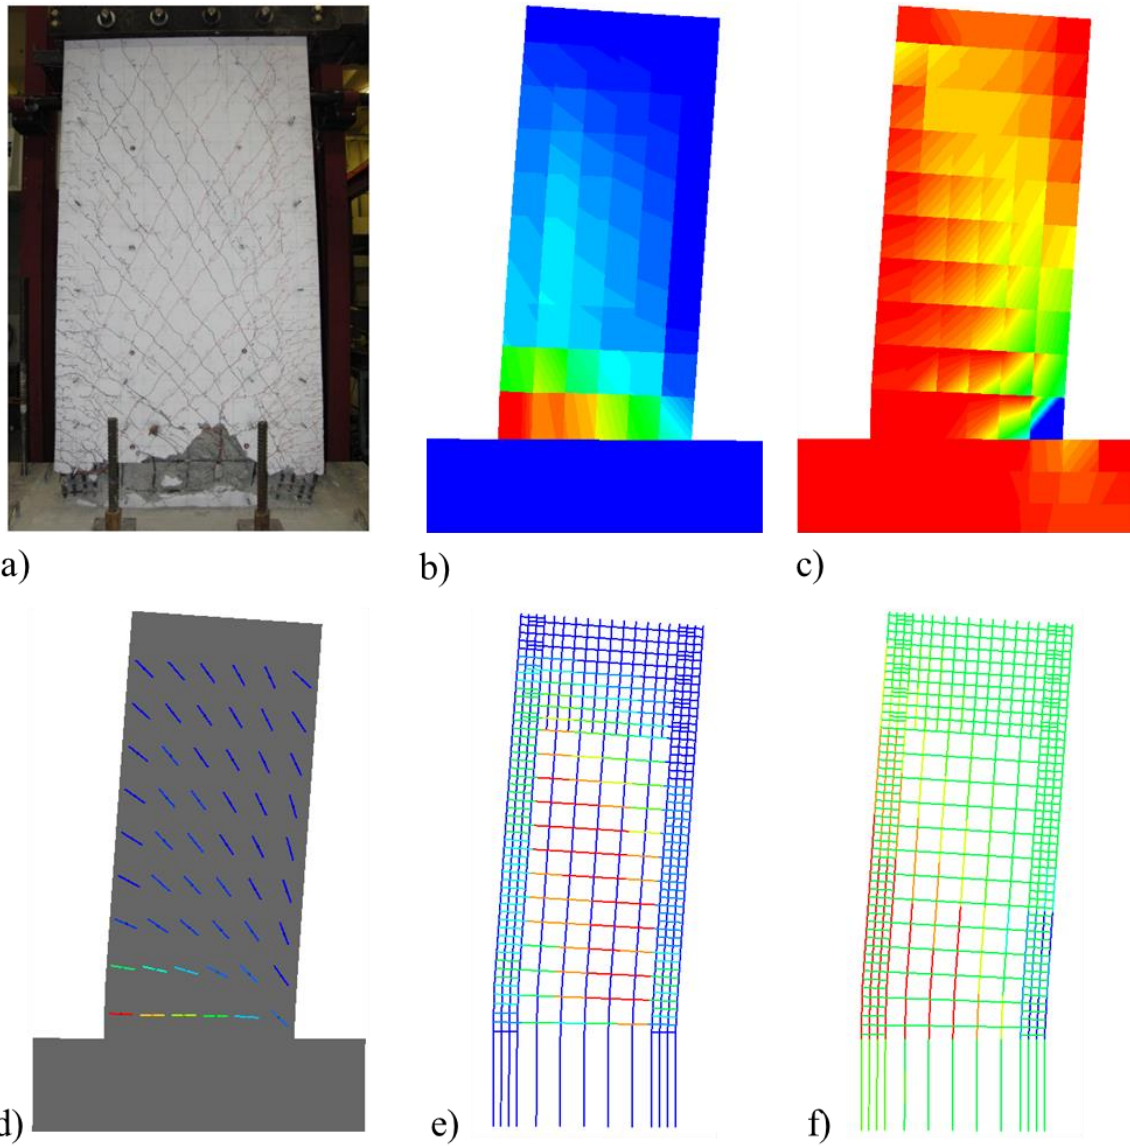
Comparación del estado de esfuerzos en el muro B cerca del punto de falla, a) Patrones de fisuración durante el ensayo al momento de la falla, b) deformaciones principales de tensión en el concreto, c) esfuerzos principales de compresión en el concreto, d) patrones de fisuración estimados, e) esfuerzos axiales en el refuerzo horizontal y f) esfuerzos axiales en el refuerzo vertical
